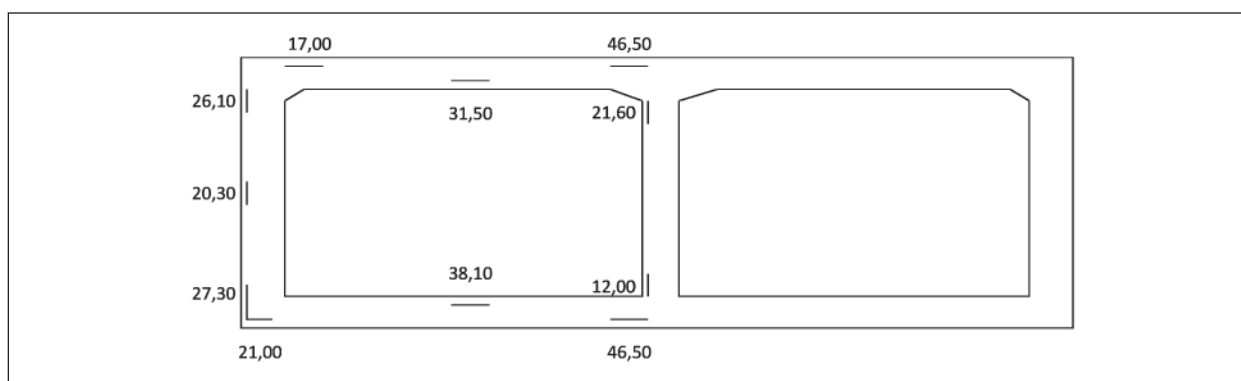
Tunnelquerschnitt RQ 26t mit maßgebender Bewehrung, Auflast 1,0 m
